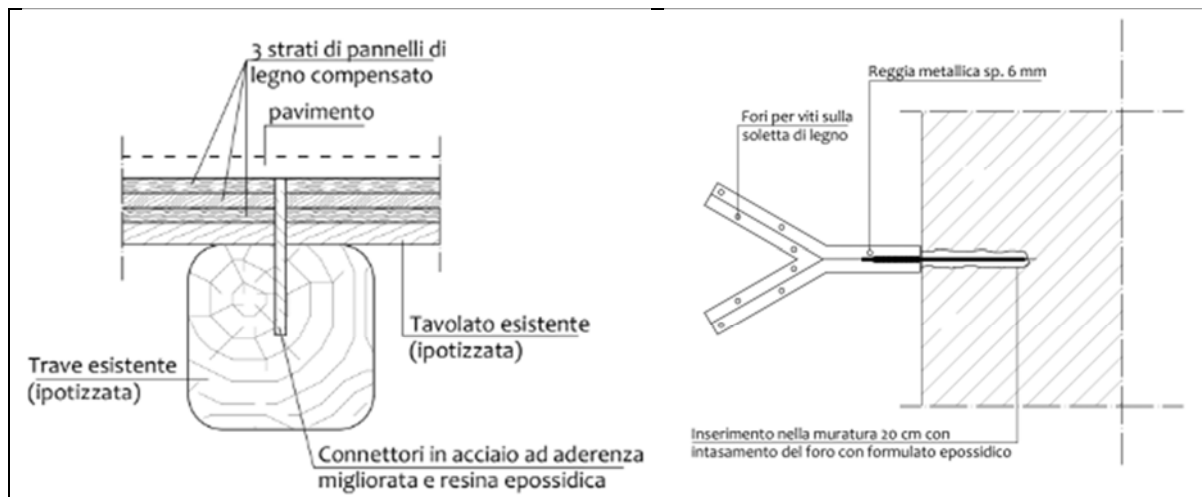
Schematizzazione dell'intervento con cappa collaborante legno-legno, sezione trasversale e schematizzazione del posizionamento della reggia metallica in pianta.
